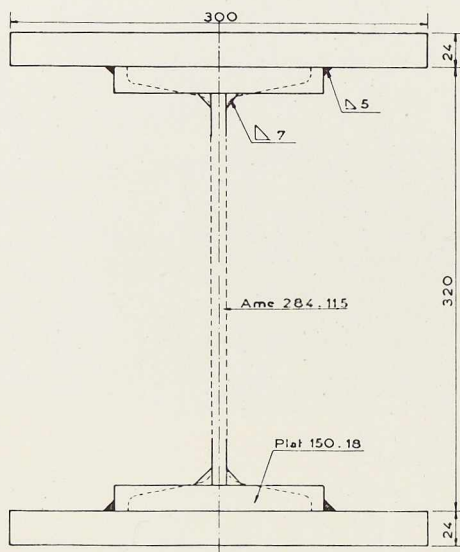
Profil composé par soudure employée pour colonnes.
